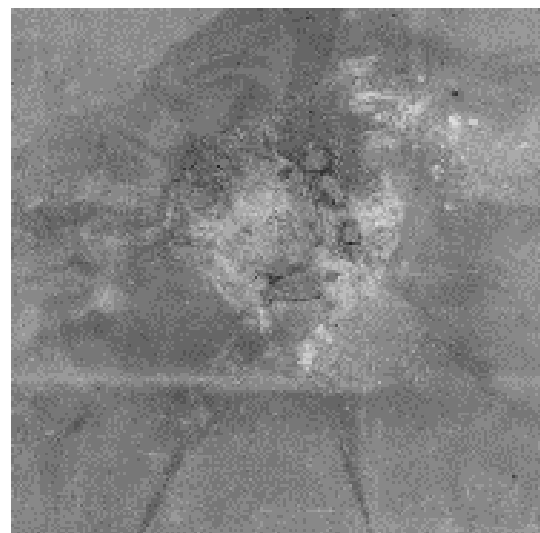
Přichycený materiál na zadní straně UHPFRC desky [111].
